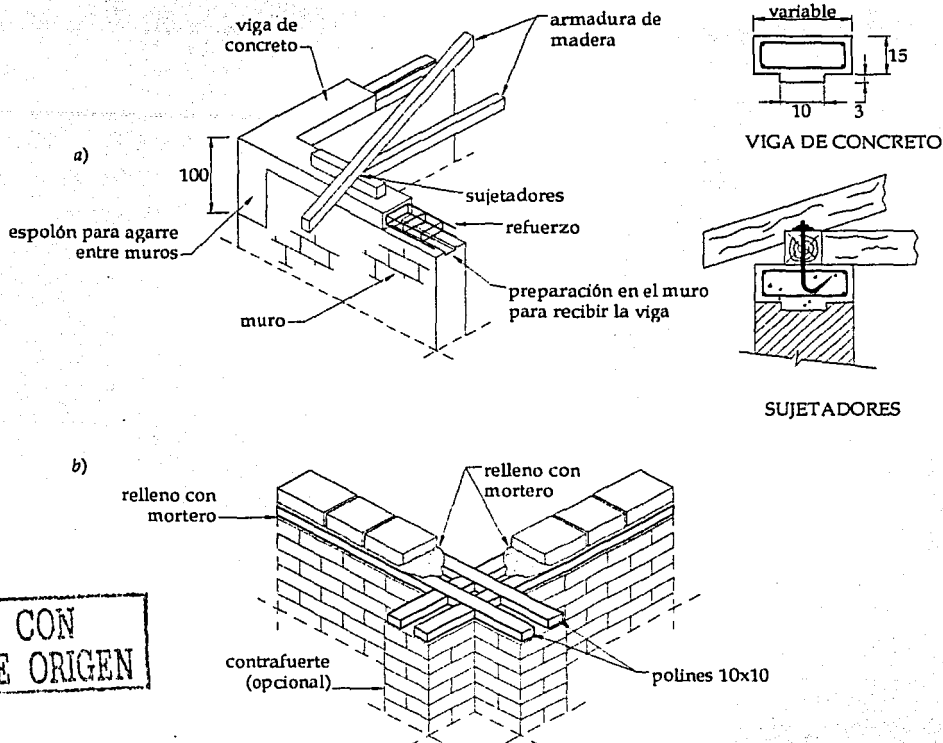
Confinamiento de muros de mampostería a base de adobe; a) viga de concreto; b) viga de madera.
